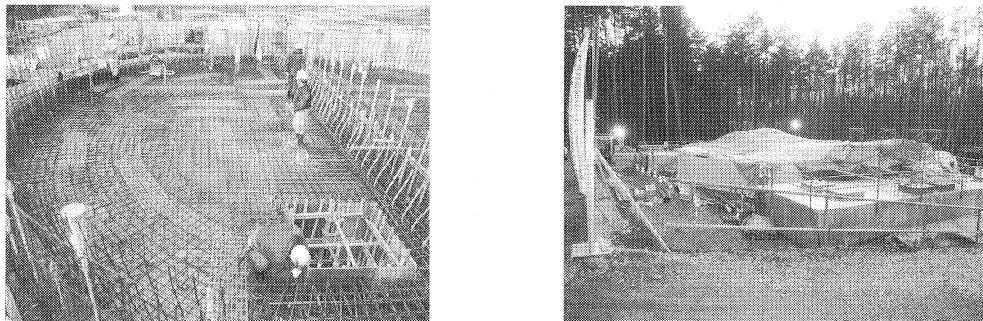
底版コンクリート打設前全景・底版コンクリート養生状況
